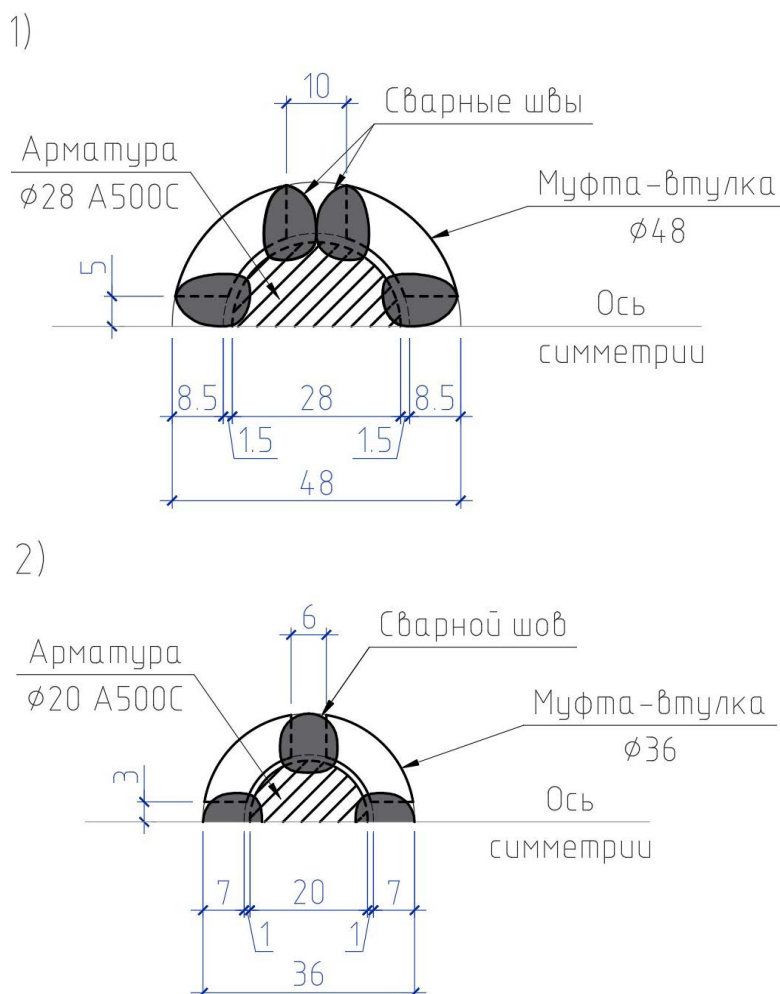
Схемы поперечных сечений сварных соединений арматурных стержней с применением муфт-втулок:
